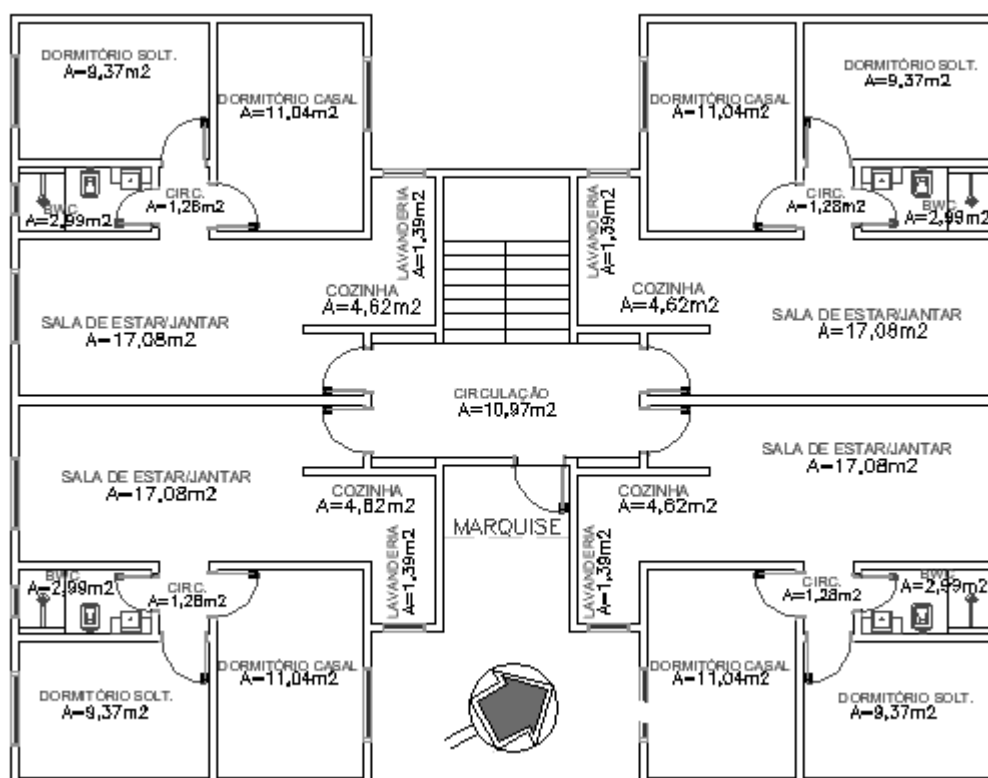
Planta baixa dos pavimentos tipo do Bloco 3 e dos Blocos 1,2 e 4
